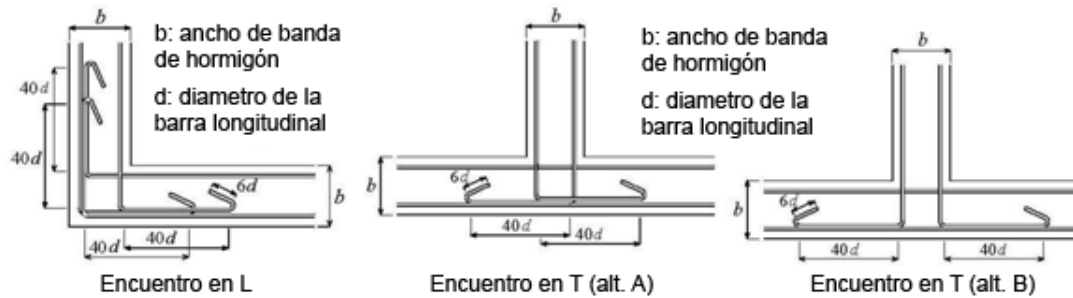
Detalle de la armadura de refuerzo longitudinal en el encuentro de bandas o viguetas de refuerzo (Schacher, 2006)
